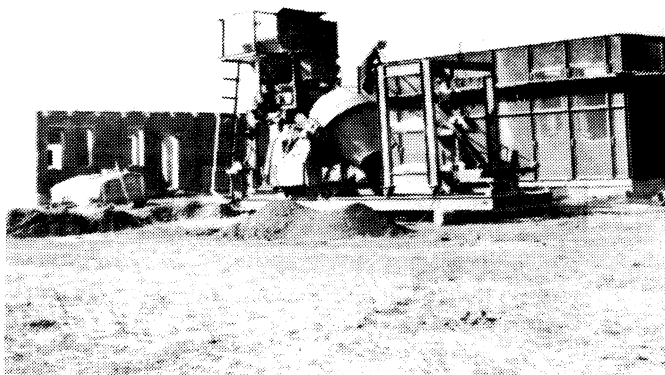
Строительство одноквартирных одноэтажных жилых домов с монолитными стенами из крупнопористого керамзитобетона в колхозе "Герой труда" Дубровенского района Витебской области. На переднем плане — бетоносмесительная установка.
